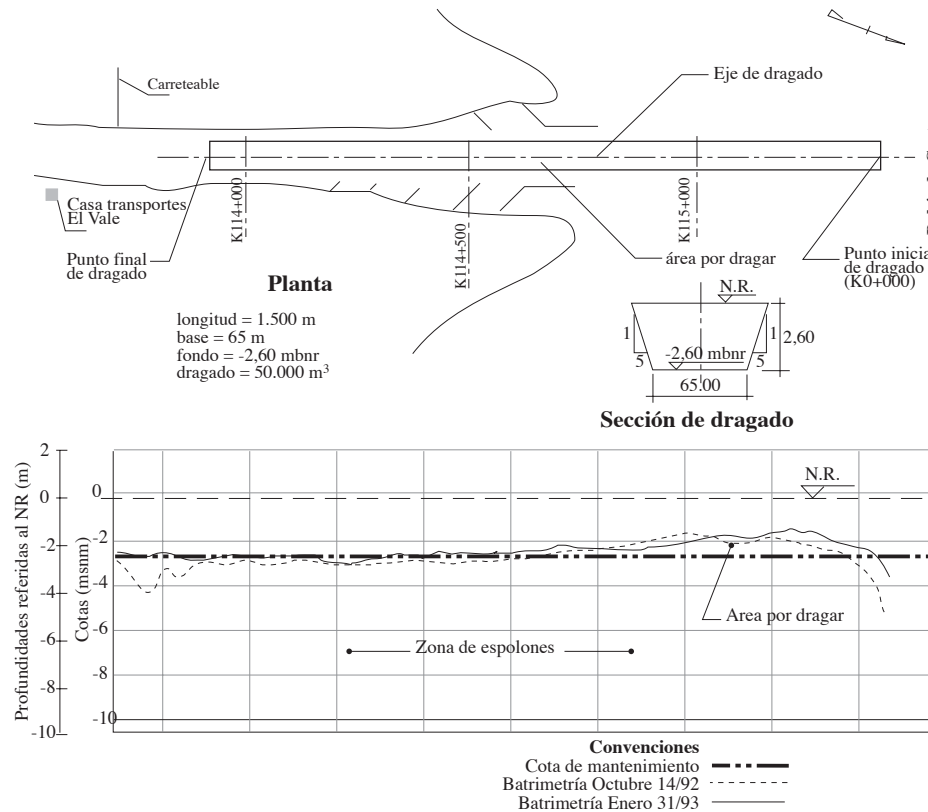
Planta (arriba) y perfil del canal de acceso en Pasacaballos
